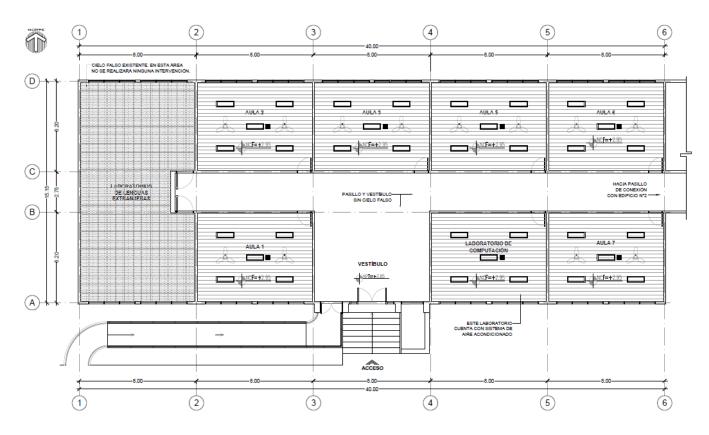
Planta de cielos reflejados y ventiladores, Segundo nivel Edificio N°1
